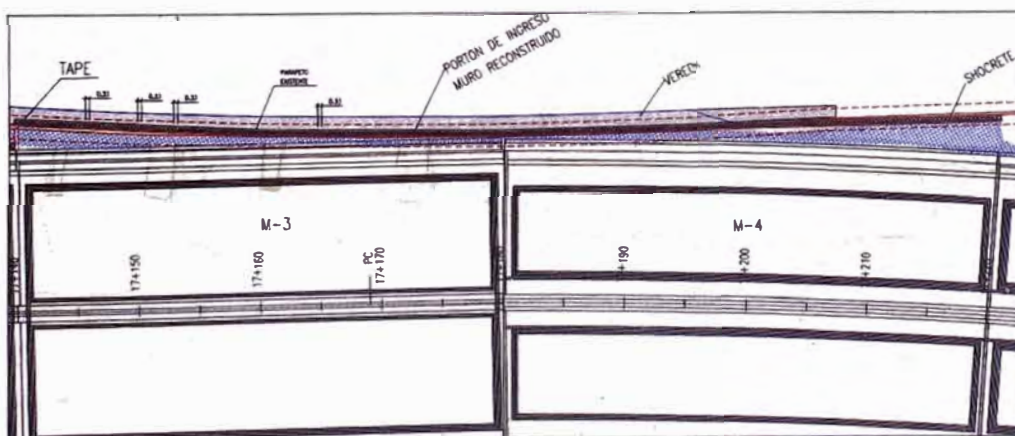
vista en planta del muro entre las progresivas 17+140 al 17+220
